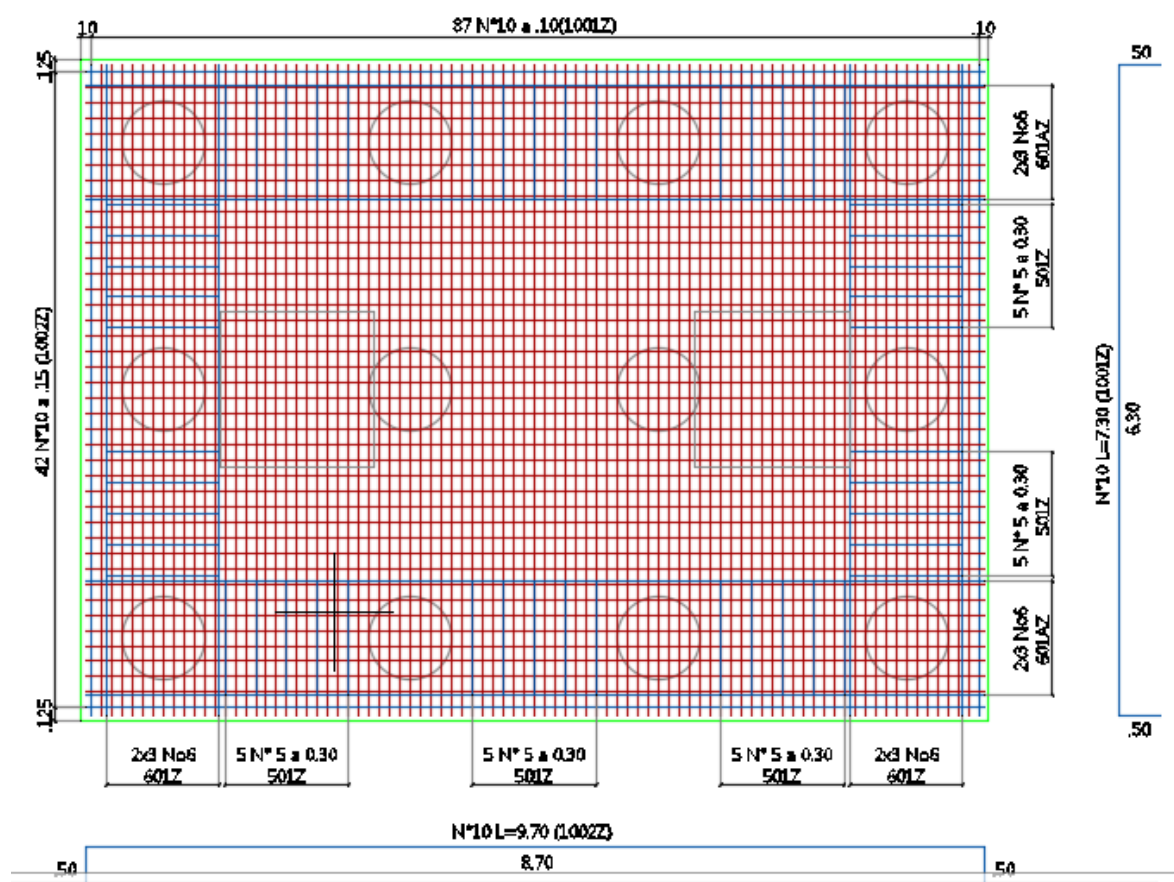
Detalle refuerzo inferior zapata sobre el eje 4. (Dis Diseñadores)
